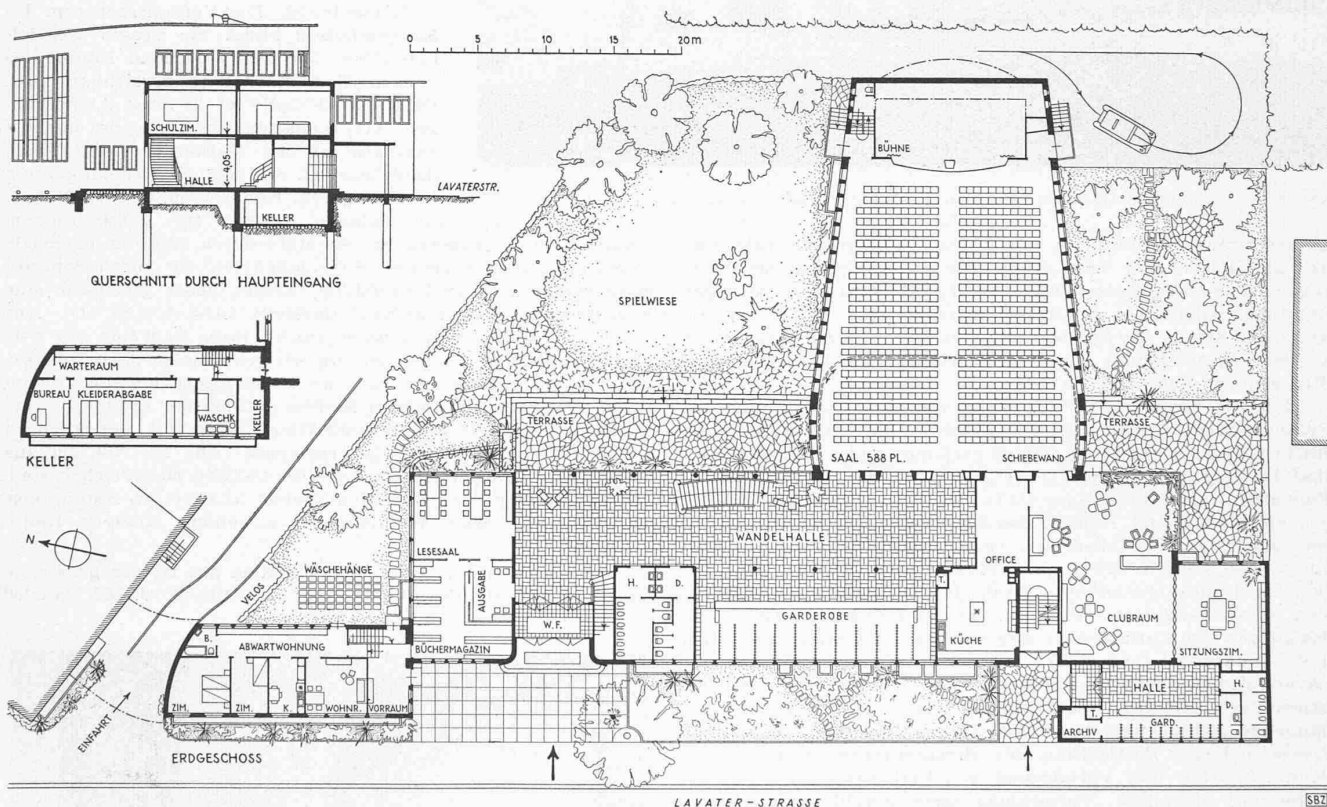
Grundrisse von Erdgeschoss und Keller, oben links Schnitt durch den Haupteingang im Schulflügel. — 1:500
